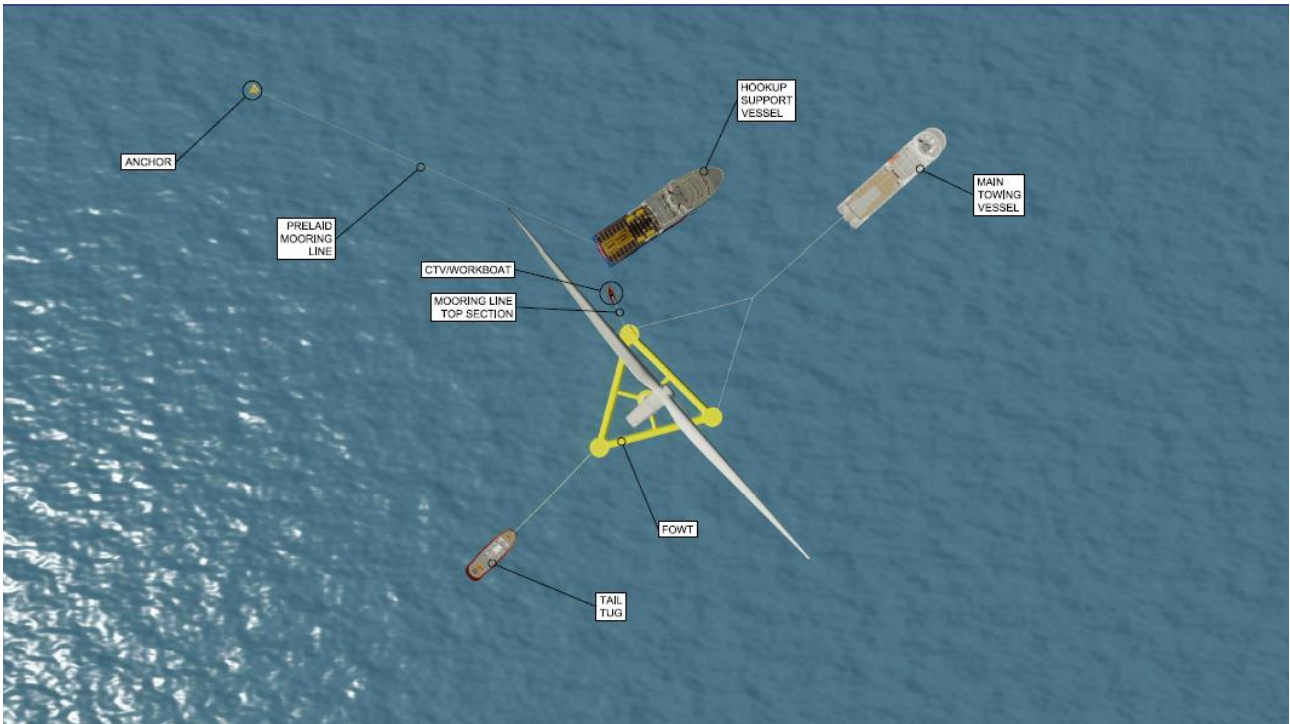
Prima linea di ormeggio agganciata vista dall'alto.
